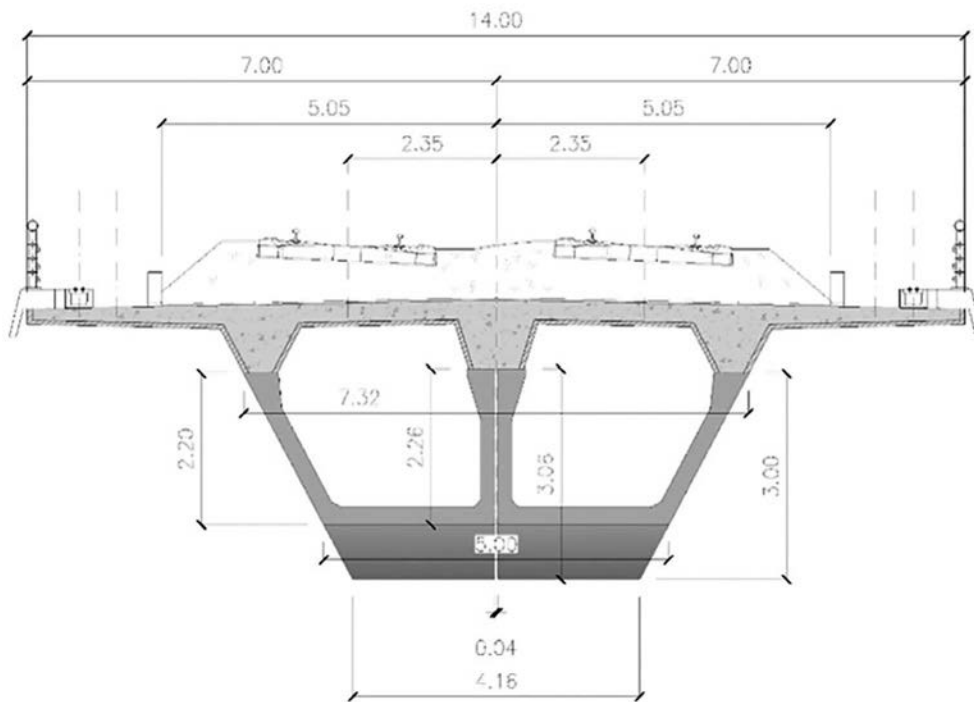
Imagen de puente para línea AVE con vigas adosadas y placa realzada, vano central 60 m.
